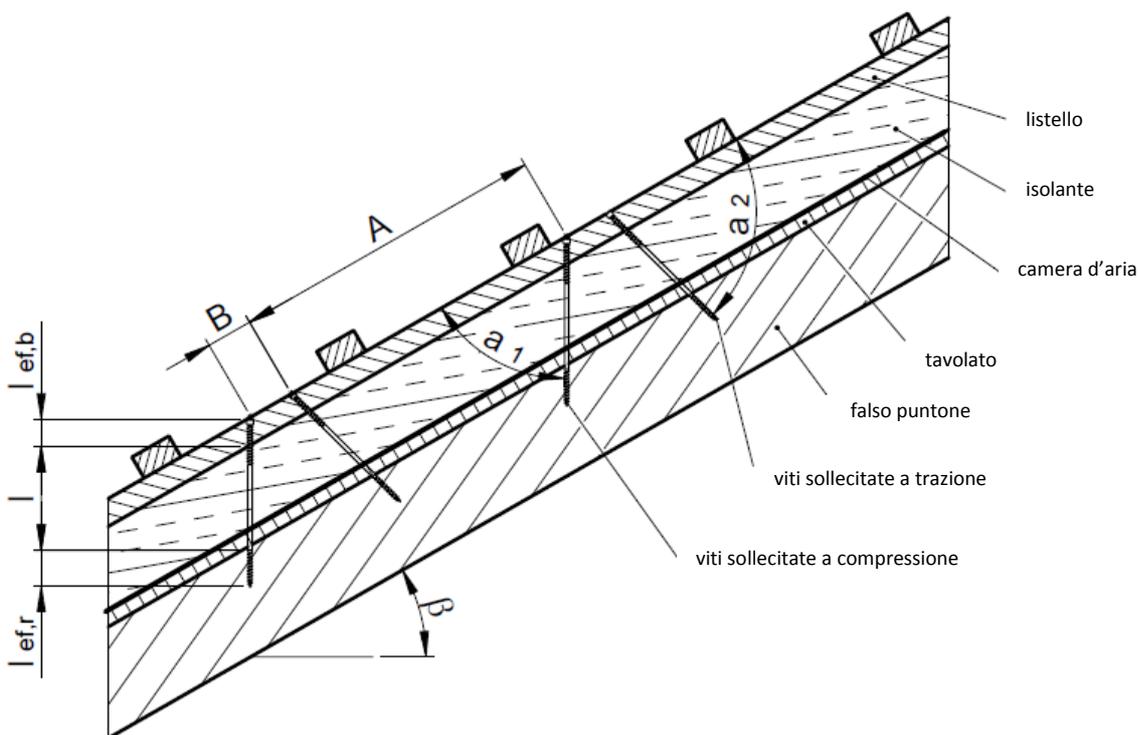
Fissaggio dell'isolante termico sui falsi puntone – sistema strutturale per viti inclinate in senso alternato
